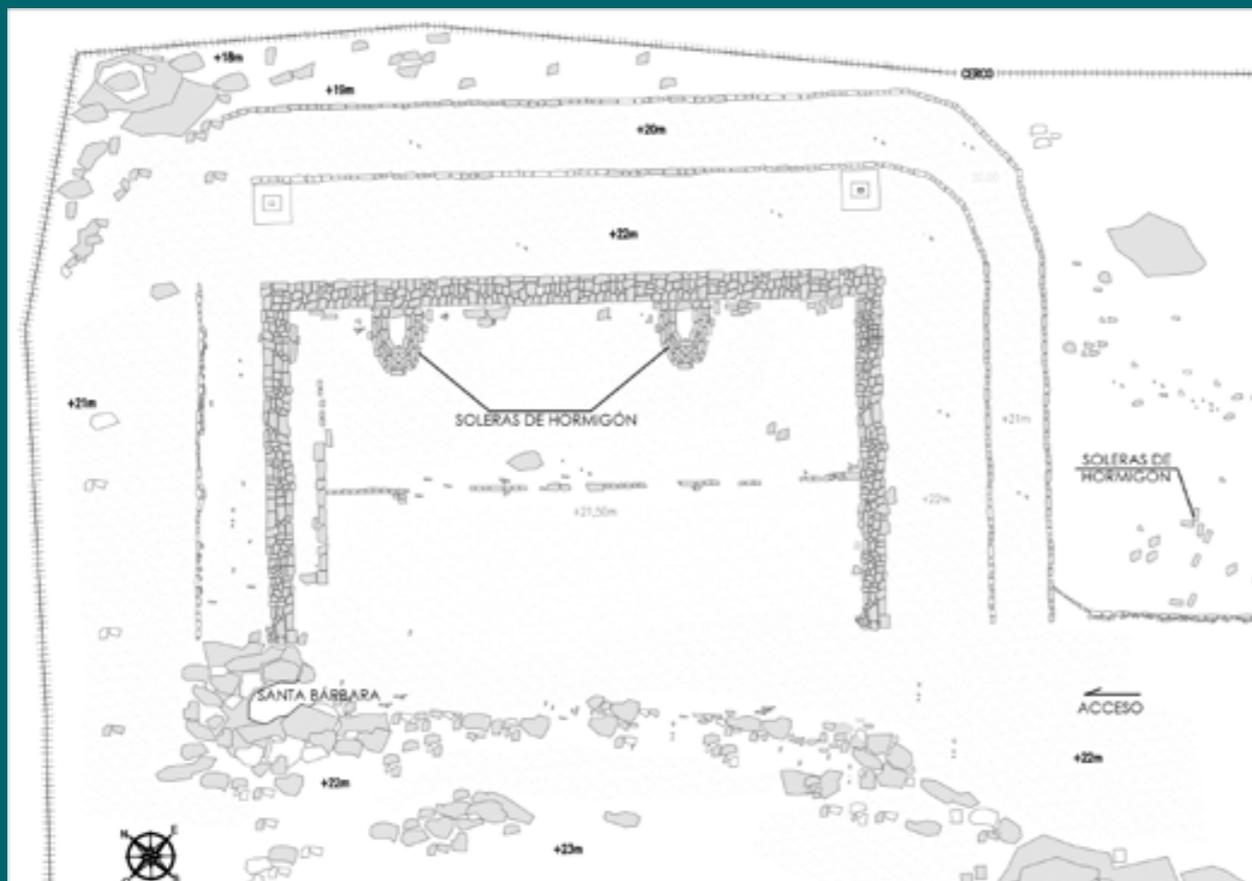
Plano de planta Fuerte Esmeralda. Autor, noviembre 2019.
